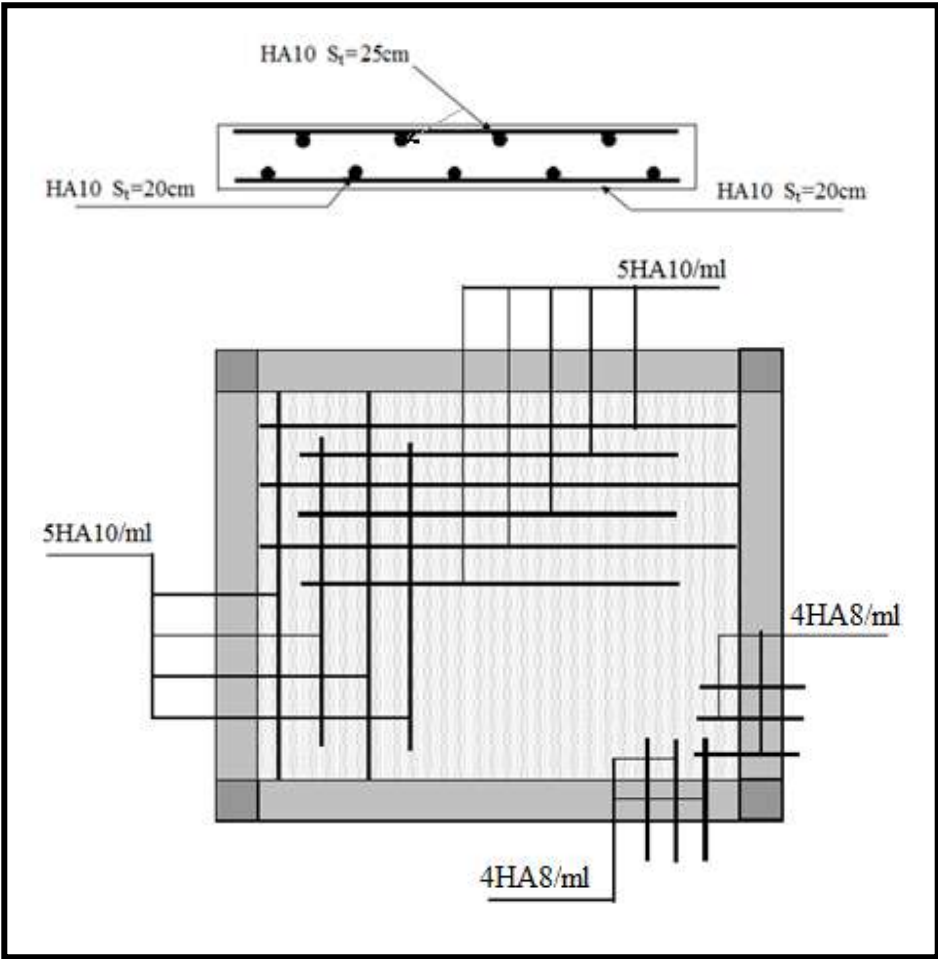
Schéma de ferrailage de la dalle sur quatre appuis.
